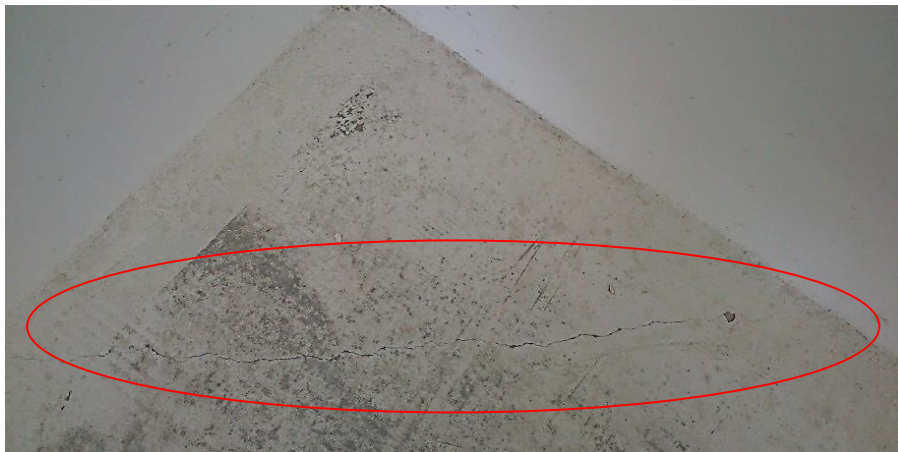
(a) *shaft* apresenta fissura longitudinal e
